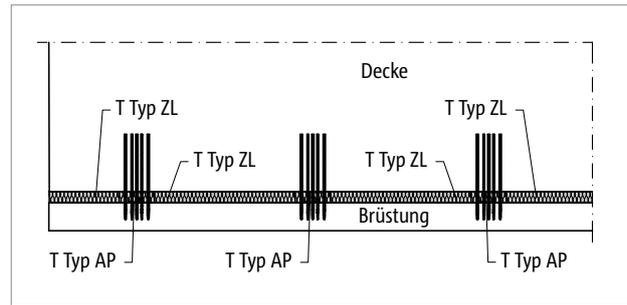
Schöck Isokorb® T Typ AP horizontale Anordnung: Grundriss Brüstung vorgesetzt
